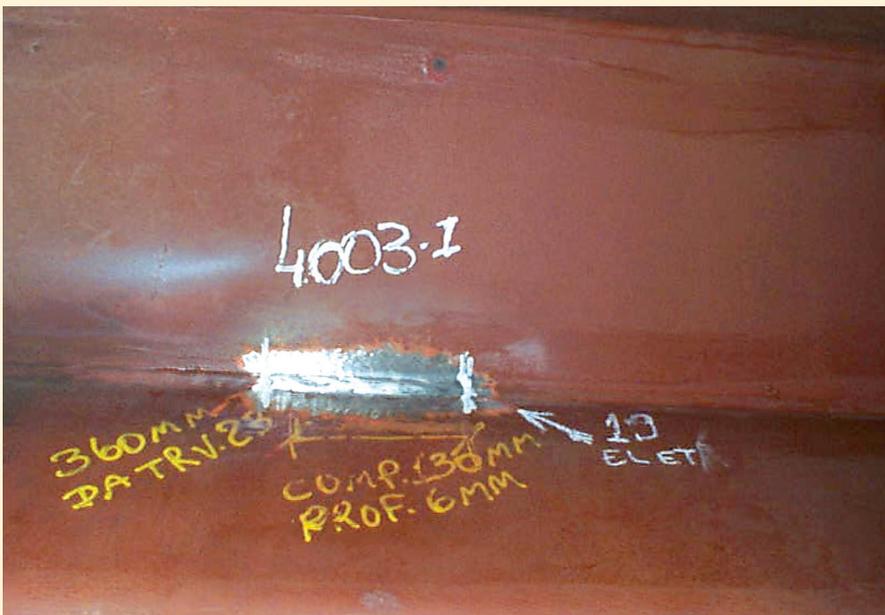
TRINCA LONGITUDINAL EM SOLDA DE FILETE NO INTERIOR DOS CAIXÕES METÁLICOS, ENTRE A MESA SUPERIOR E O ENRIJECEDOR TRAPEZOIDAL (FONTE: RELATÓRIO DE VISTORIA – 1993)
